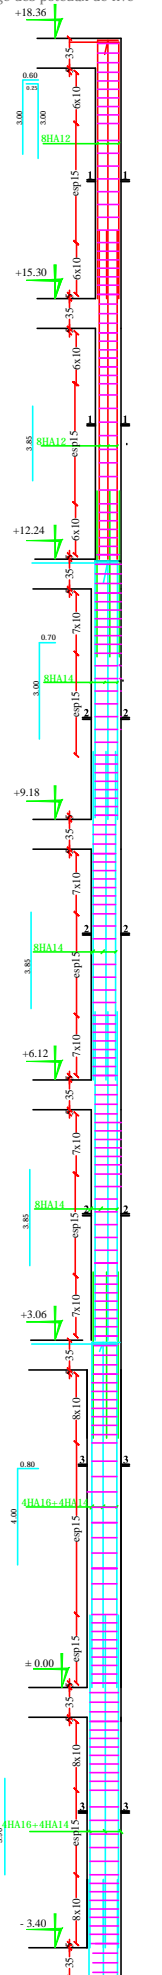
Disposition des armatures dans les poteaux (30x30)
